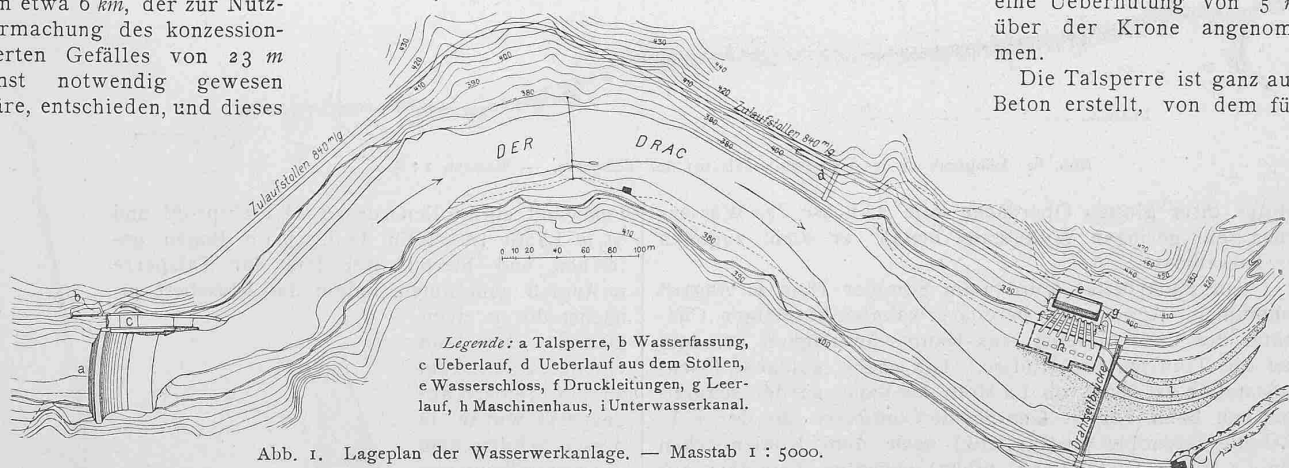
Lageplan der Wasserwerkanlage. — Masstab 1 : 5000.
